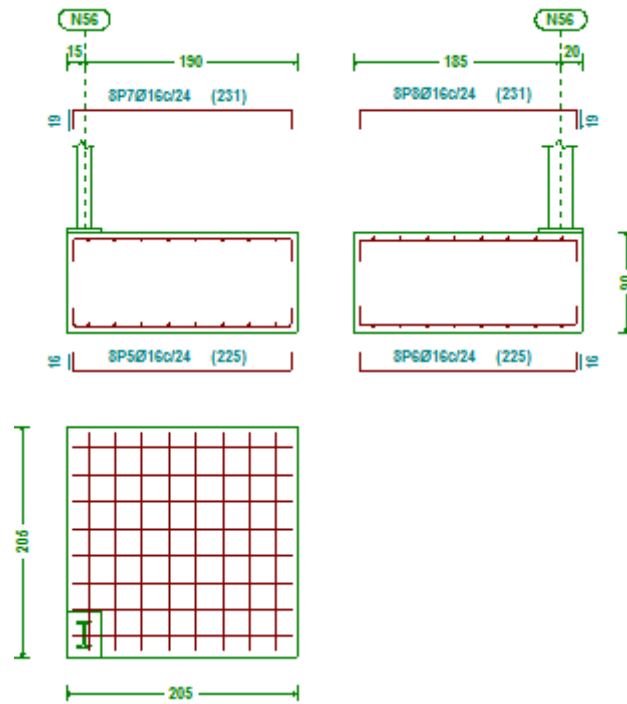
Zapata pilar exterior izquierdo del pórtico de fachada (Tipo 8)
